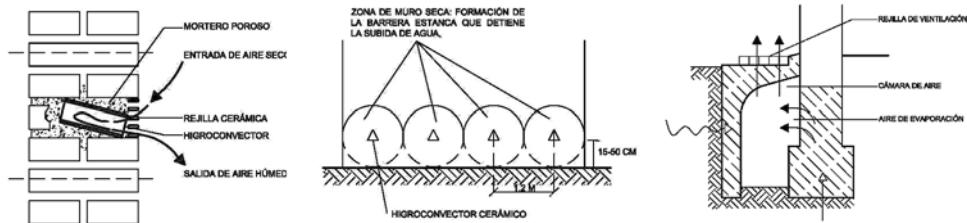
En el gráfico de la izquierda, ubicación de un ladrillo de ventilación en la sección del muro. En el del centro, disposición de los ladrillos para formar la sección horizontal estanca en el muro. En el de la derecha, esquema de una cámara de ventilación perimetral para propiciar el secado del muro húmedo.
